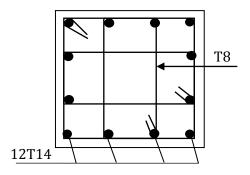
Schéma de ferraillage des poteaux 8, 9, 10 et 11éme étage
